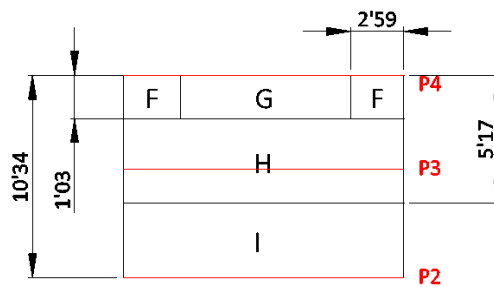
Modelo de cargas debidas al viento frontal sobre los pórticos de la segunda planta.
